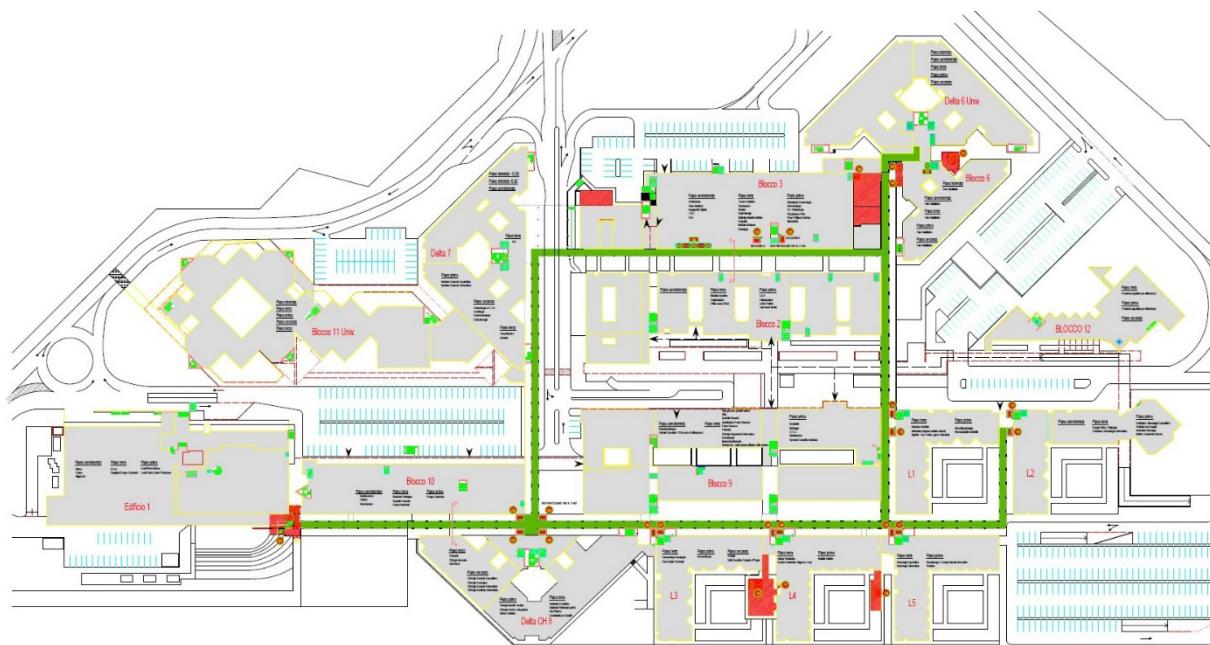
La planimetria attuale dell'ospedale San Salvatore mostra, oltre ad una realizzazione diversa rispetto al progetto iniziale, l'attuale prevalenza attribuita al percorso anulare rispetto all'asse di attraversamento longitudinale (ASL1 Abruzzo, Ufficio tecnico).
